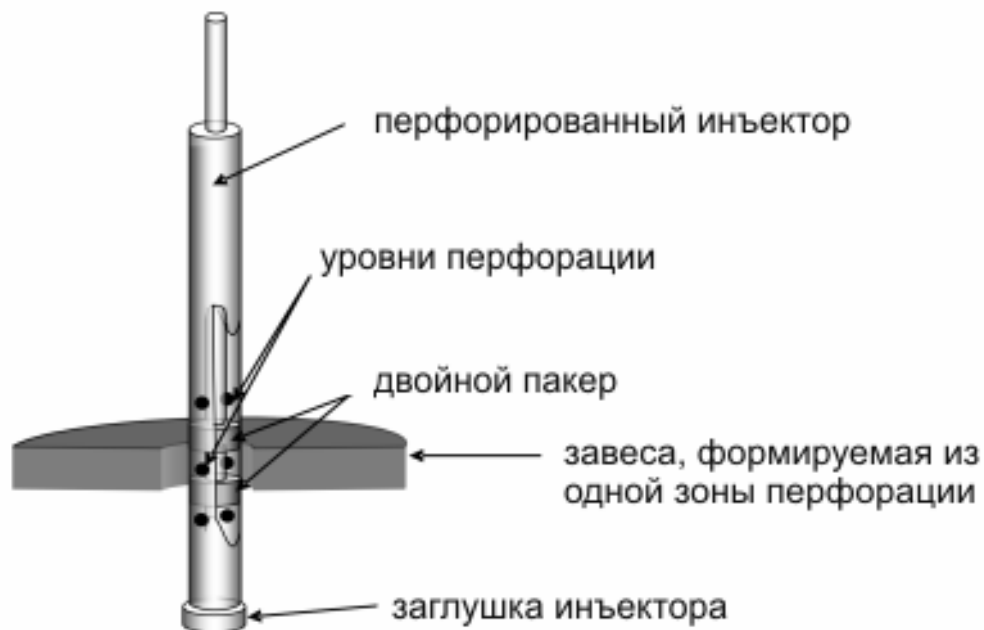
Устройство и принцип действия двойного пакерующего устройства
